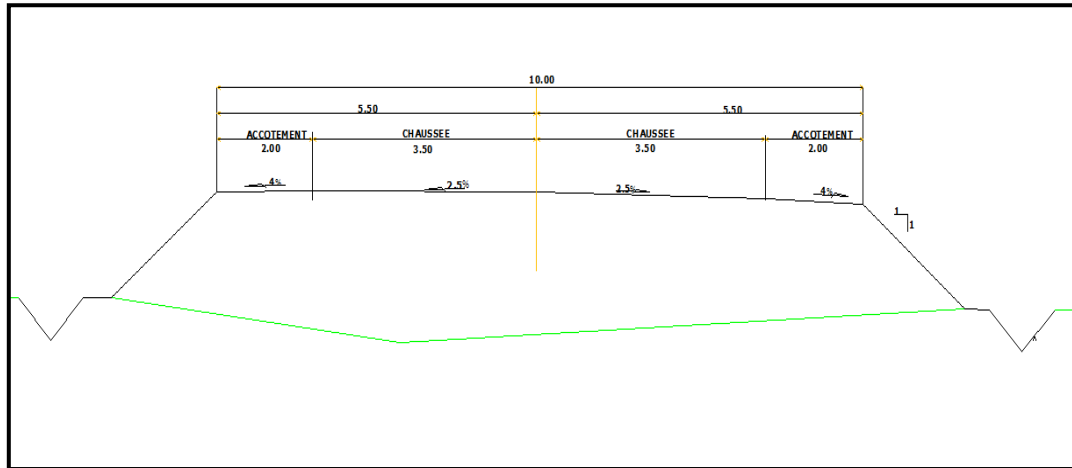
2:Schéma explicatif d'une coupe transversale de la chaussée prévue.
